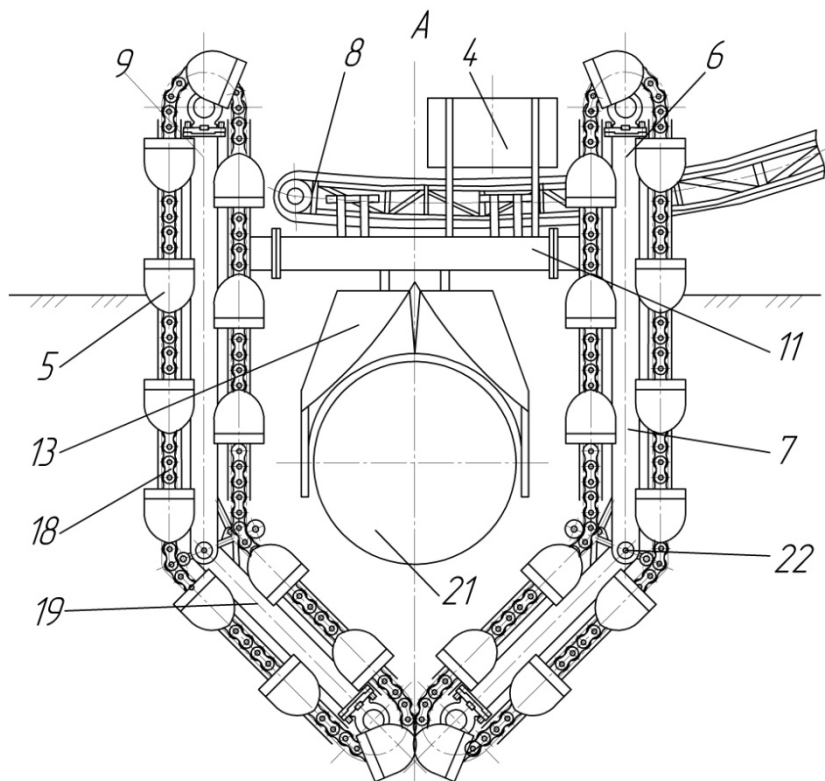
Багатоковшевий адаптований робочий орган поперечного копання, вид А на рис. 1
